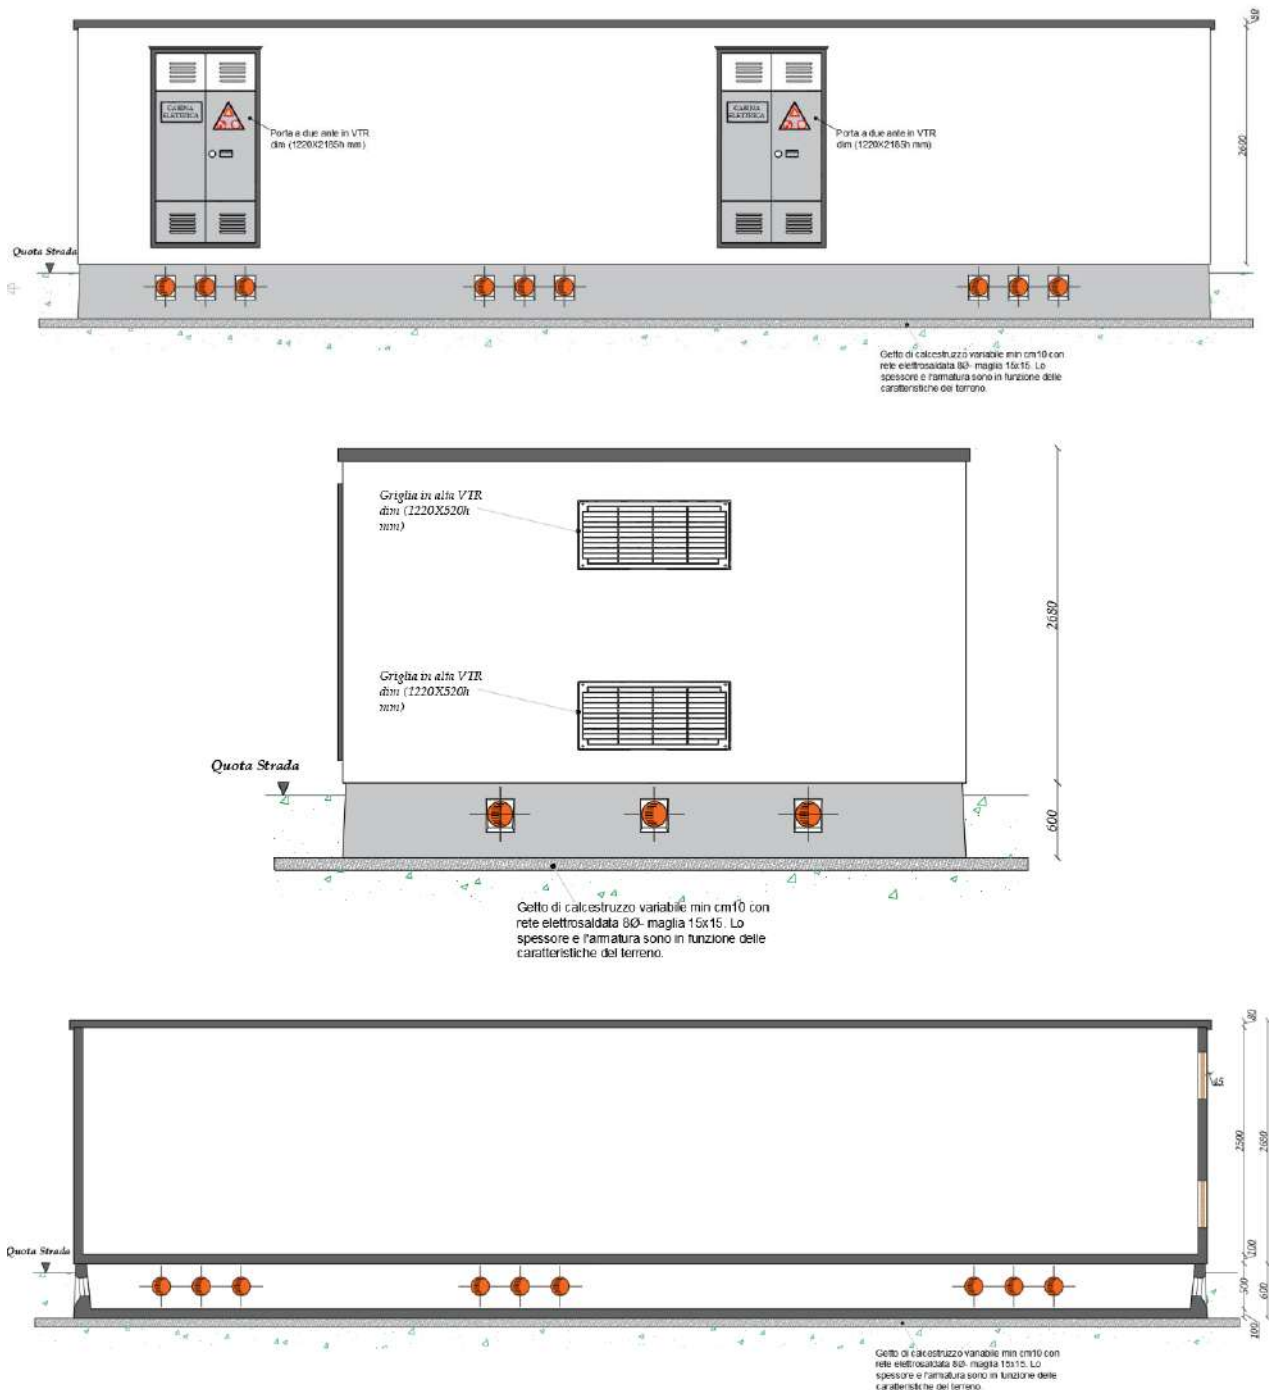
Cabina di raccolta a 36 kV: Pianta, prospetti e sezioni.
